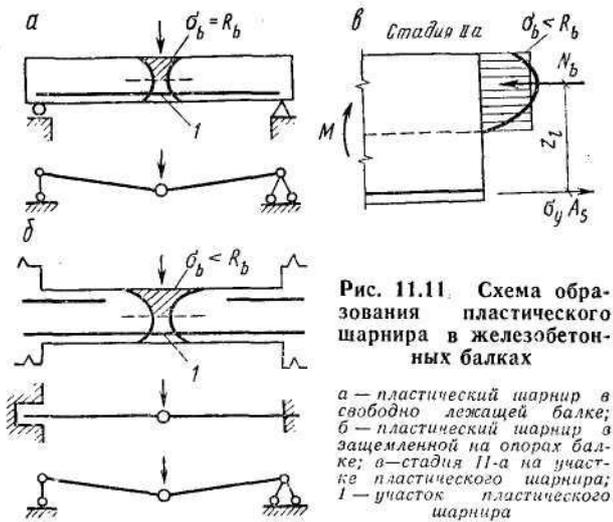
Схема образования пластического шарнира в железобетонных балках
